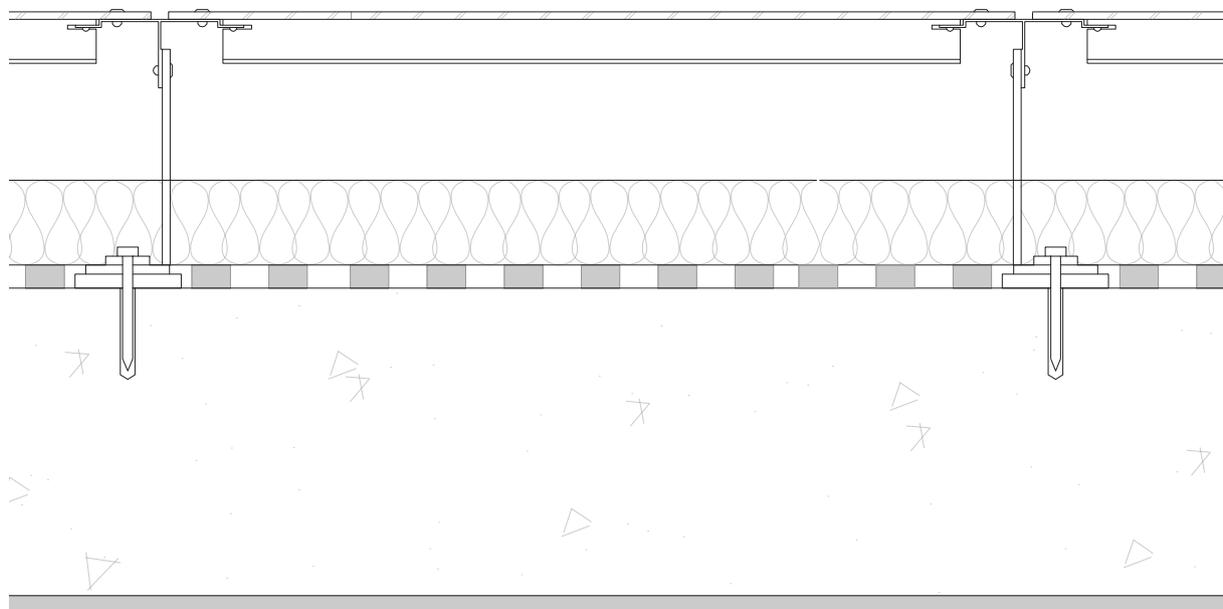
Pormenor construtivo, fixação dos painéis -Planta.
